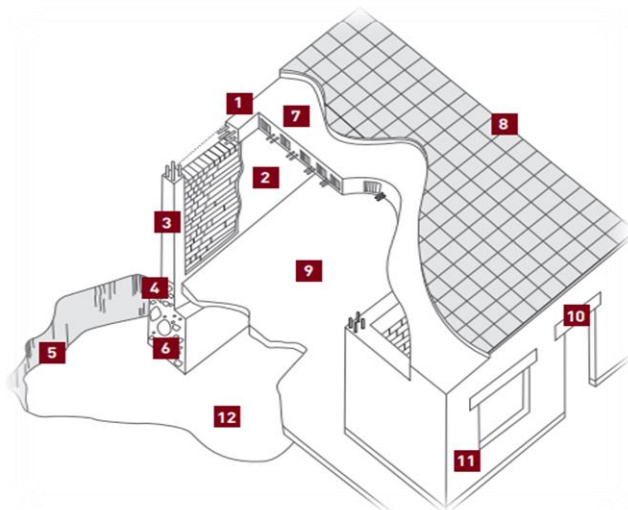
Elementos estructurales de construcción tradicional en ladrillo
